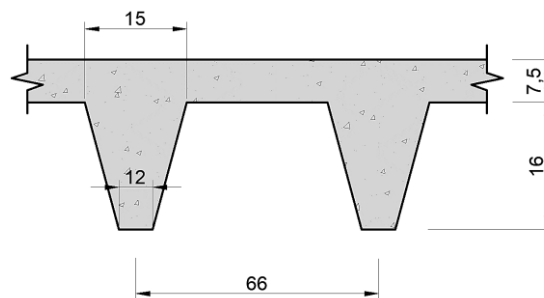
Projeto A2 - Seção da laje nervurada (dimensões em cm).
